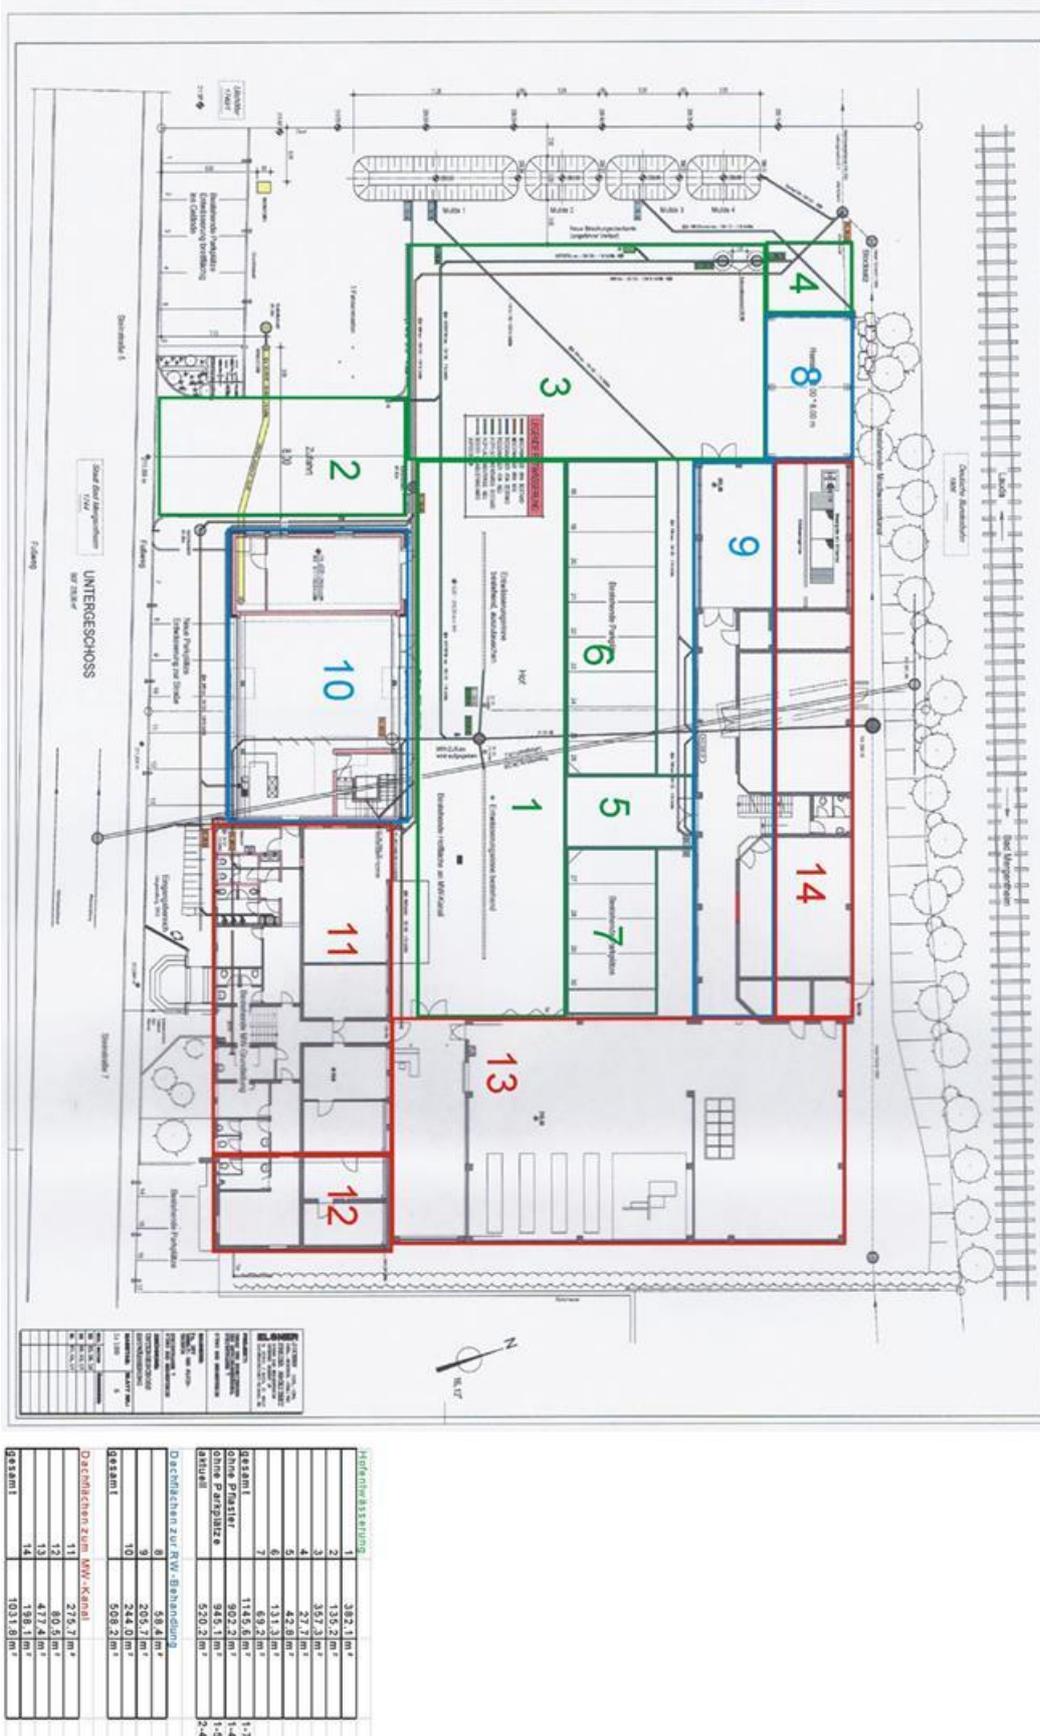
Lageplan mit eingezeichneten Hoffflächen (grüne Umrandung)
